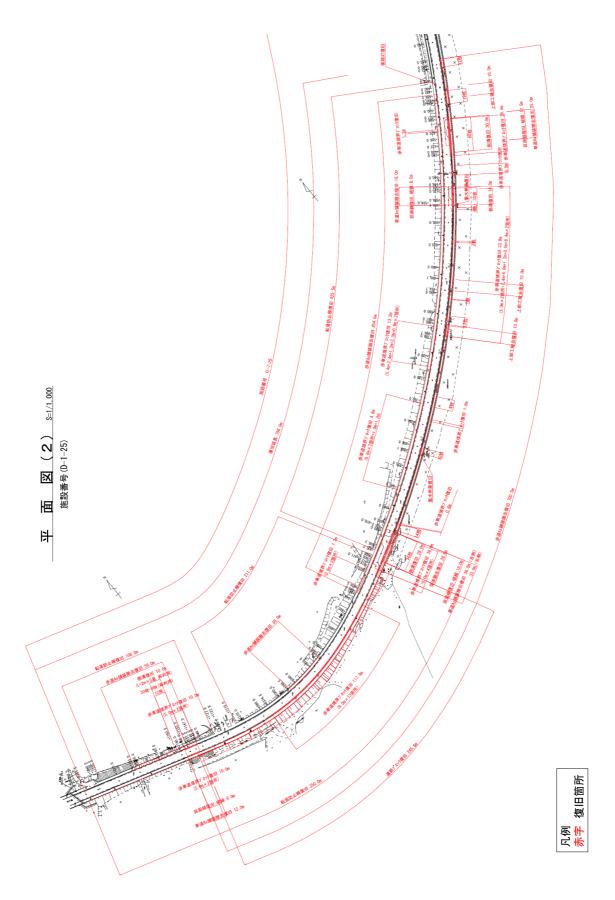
161 No. 1 臨海道路湾岸線平面図 No.2 (復旧後)
